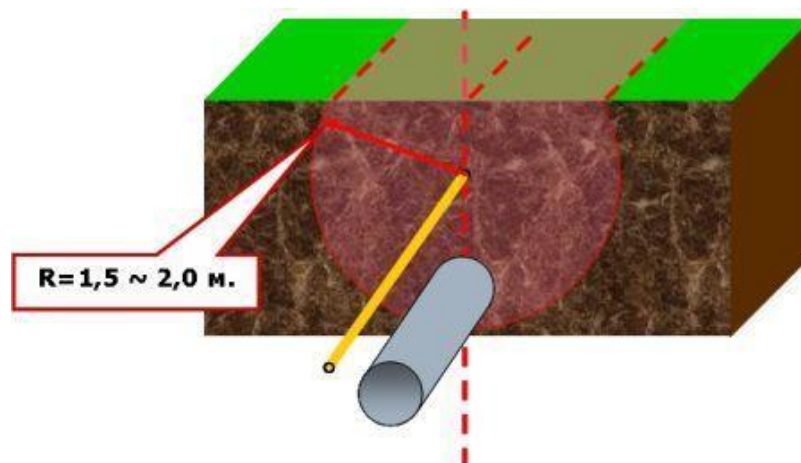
Схема укладки (размещения) оптоволоконного кабеля-датчика
